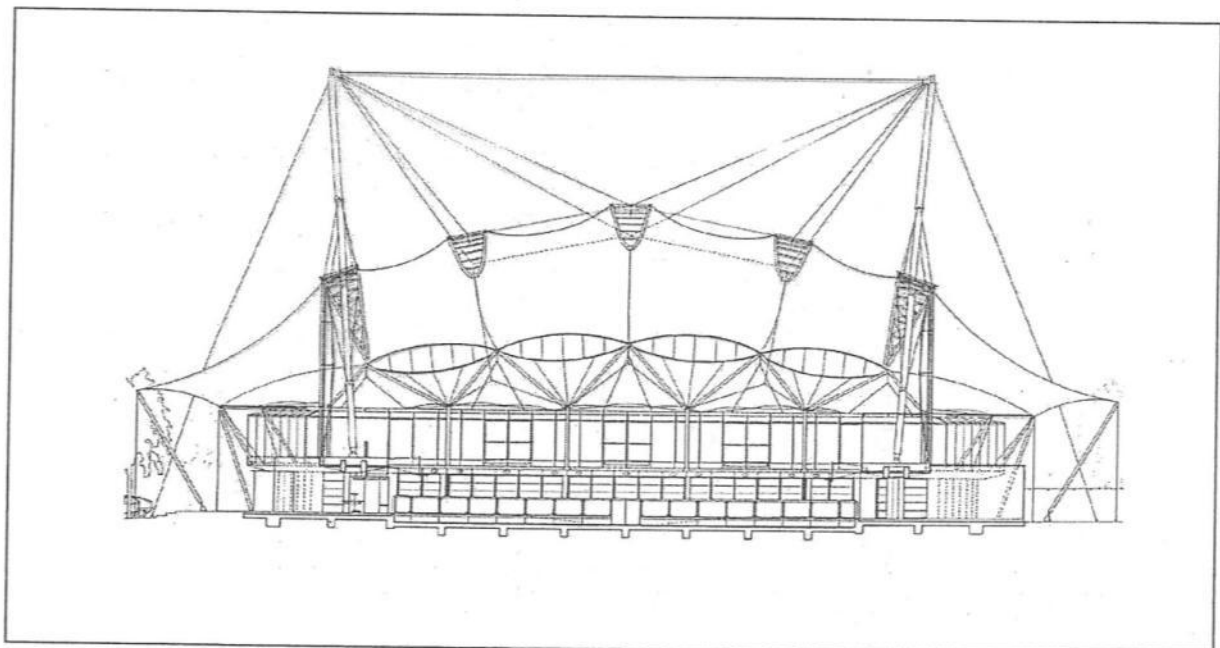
d: Corte longitudinal. Los cables traccionados sujetan la cubierta desde el exterior.
